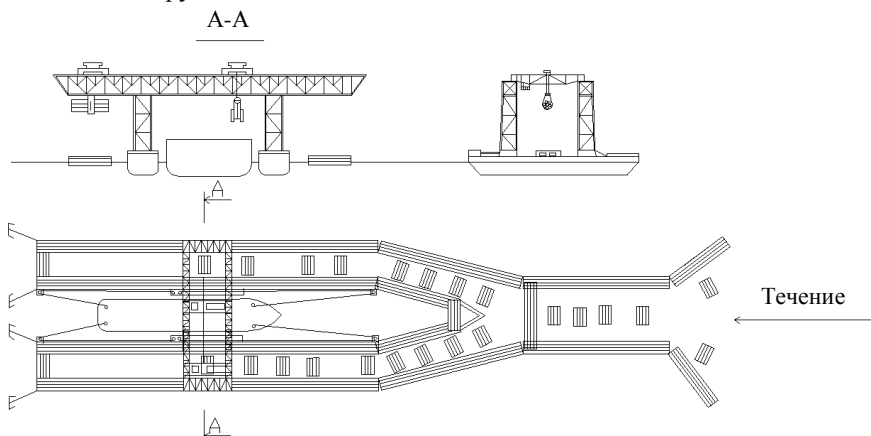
Схема механизации перегрузки леса в пучках из воды в суда специальным перегружателем
